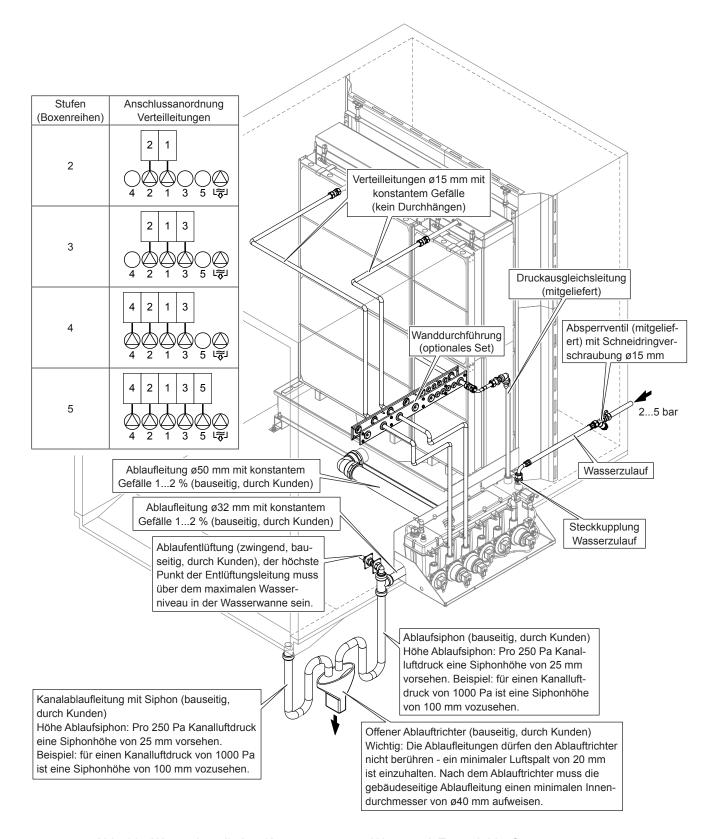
Wasserinstallation (Aussenmontage, Wanne mit Zentralablauf)
